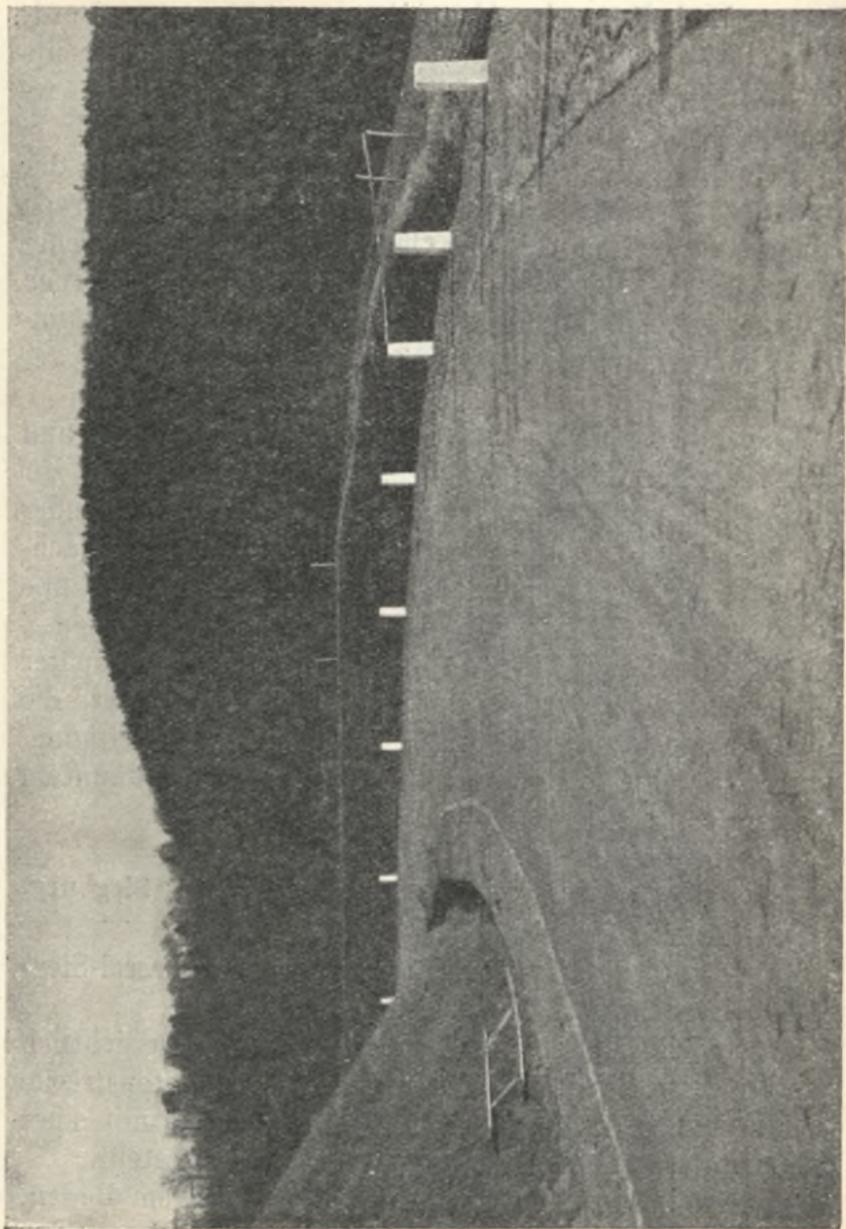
Betonstrecke der Wahntalstraße bei Siegburg.
